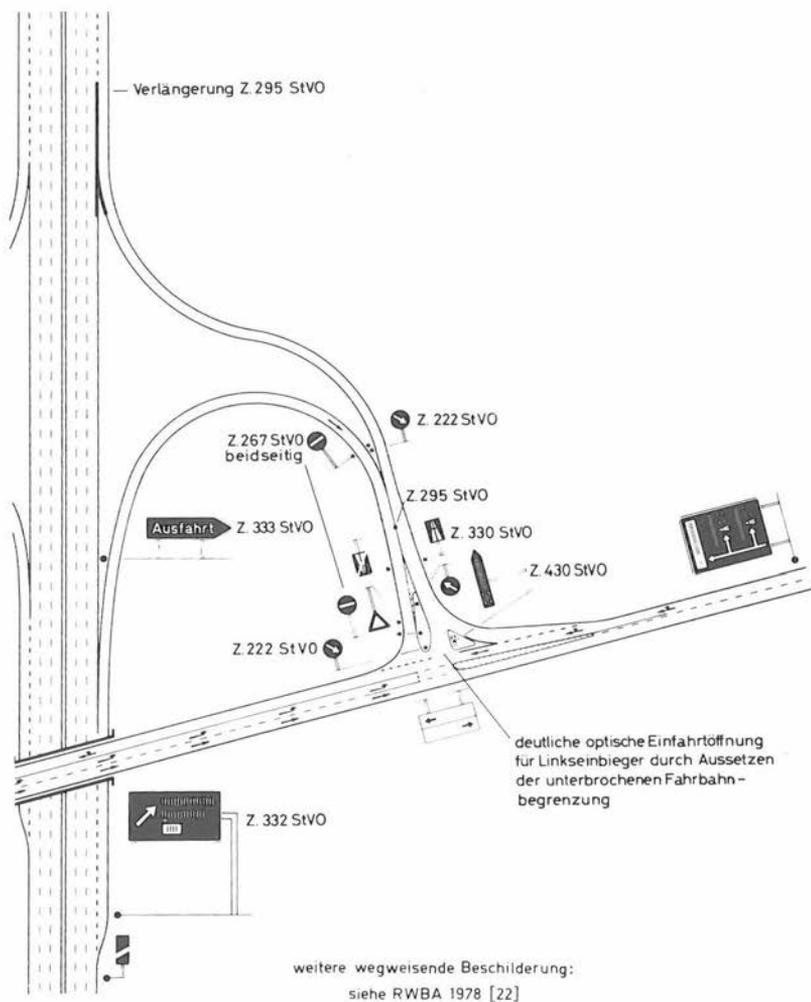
Beschilderung und Markierung einer Anschlussstelle
